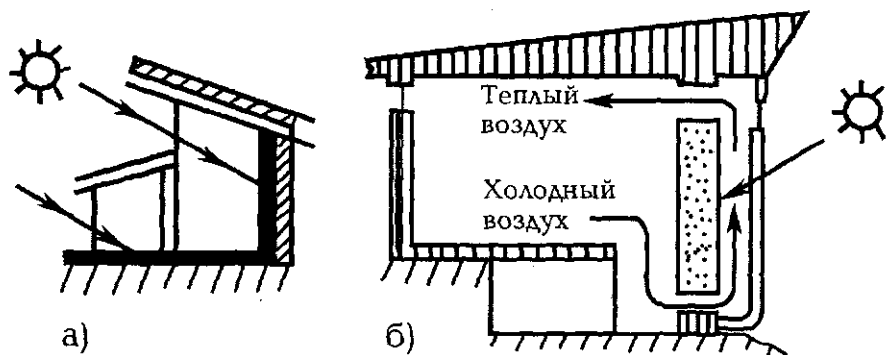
Пассивные солнечные нагреватели: а – прямой нагрев задней стенки здания; использованы массивные, окрашенные в черный цвет поверхности с усиленной теплоизоляцией для поглощения и накопления солнечной теплоты; б – здание с накопительной стенкой.
